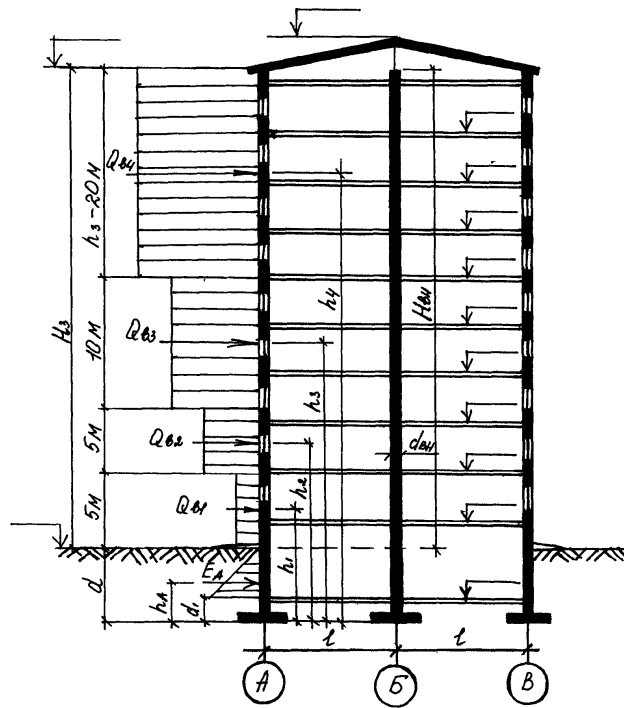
Схема до визначення навантажень на фундаменти
